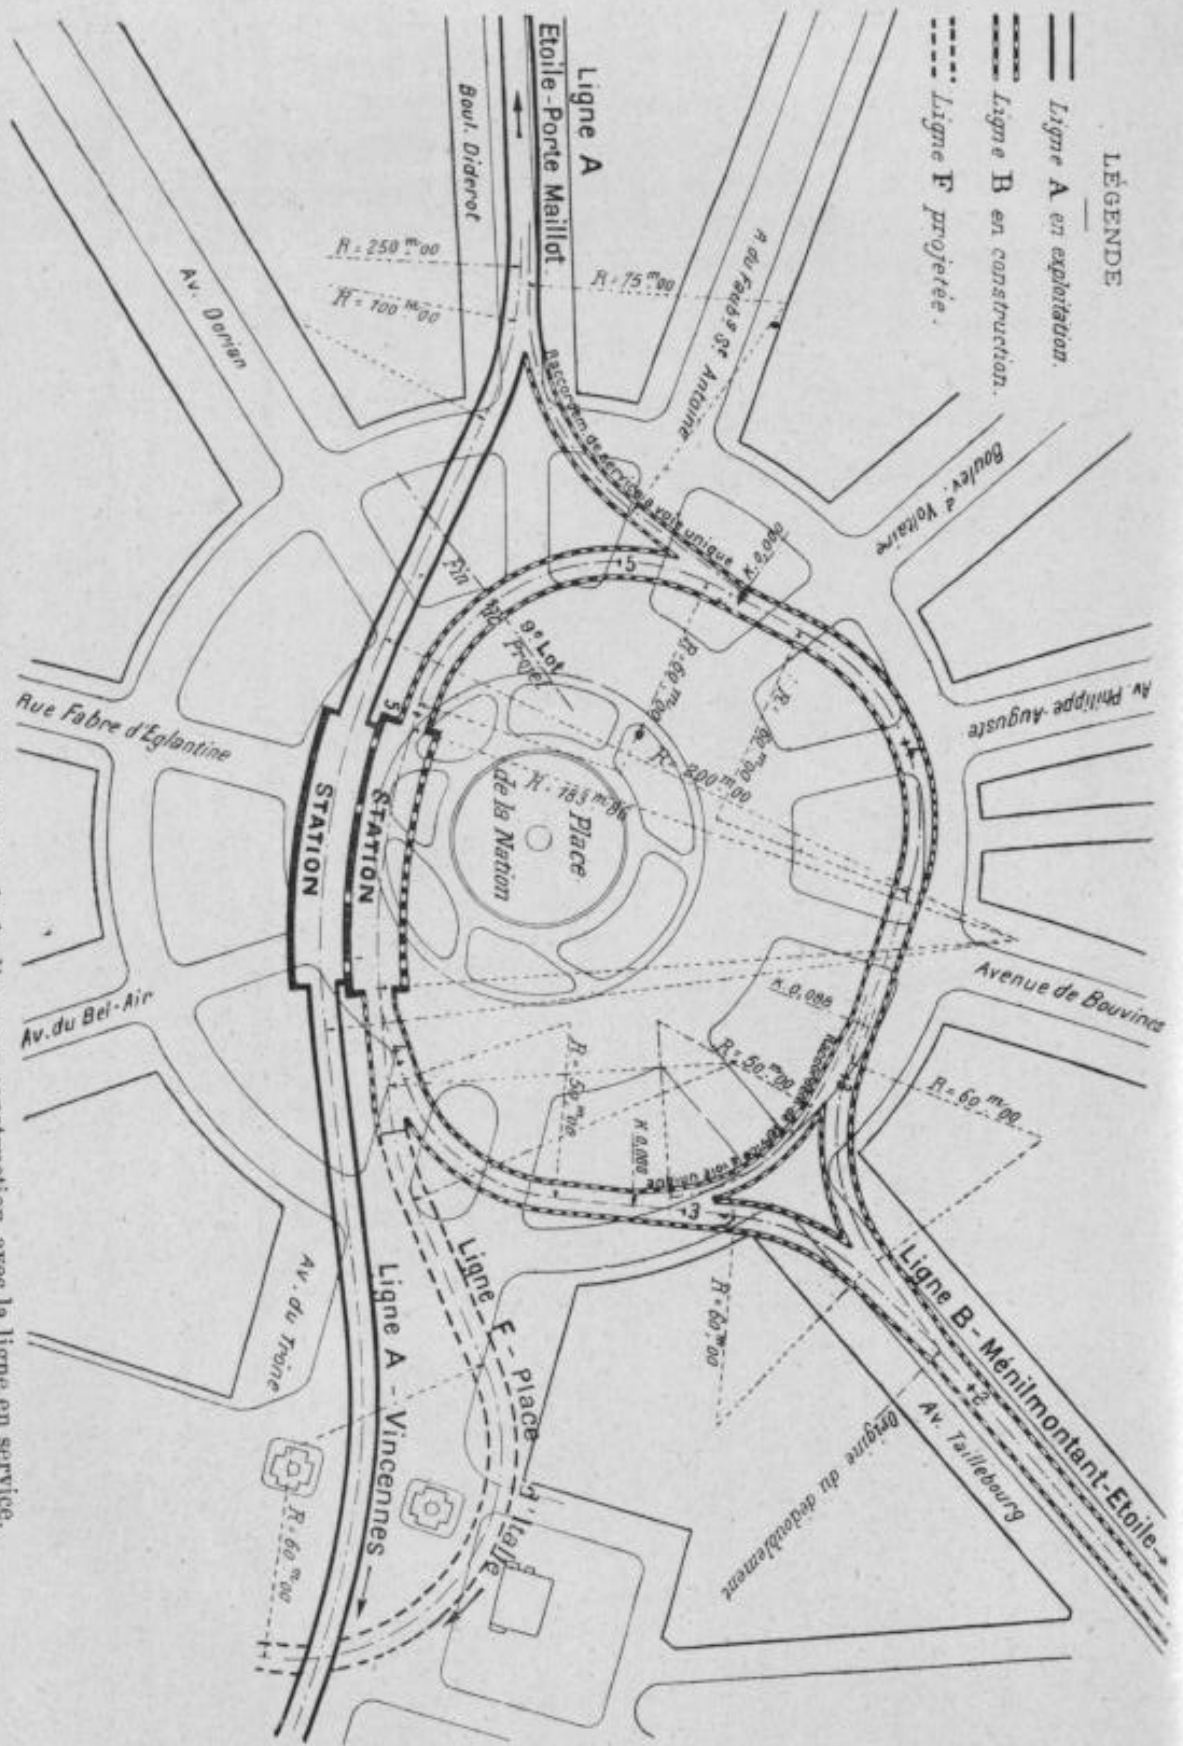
Point de contact, place de la Nation, de la ligne en construction avec la ligne en service.
